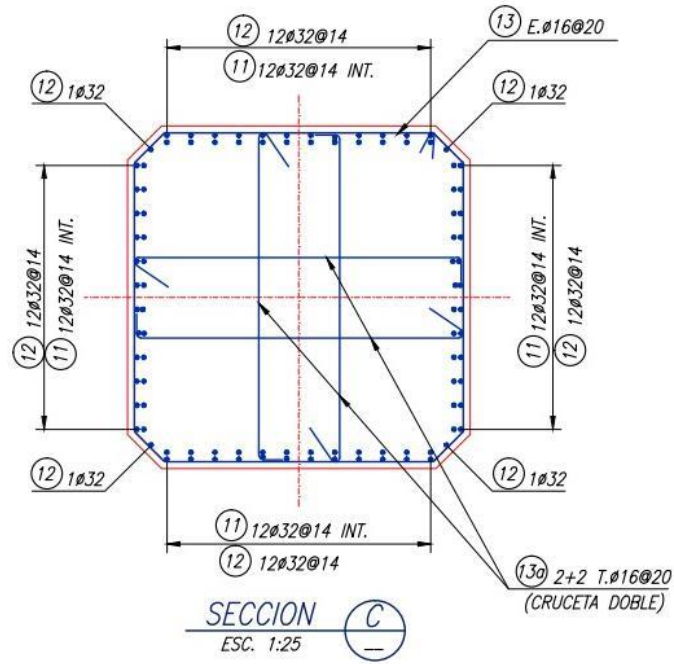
25 Sección Cepa 9 Planos (Astaburuaga,2020).
